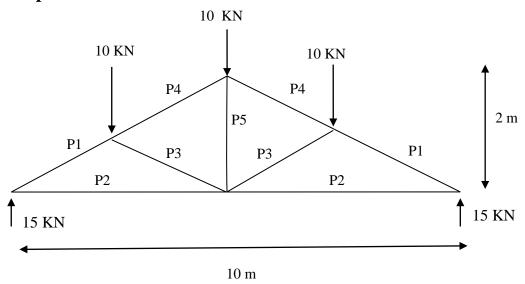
Exemple d'un treillis plan 10 m de portée
